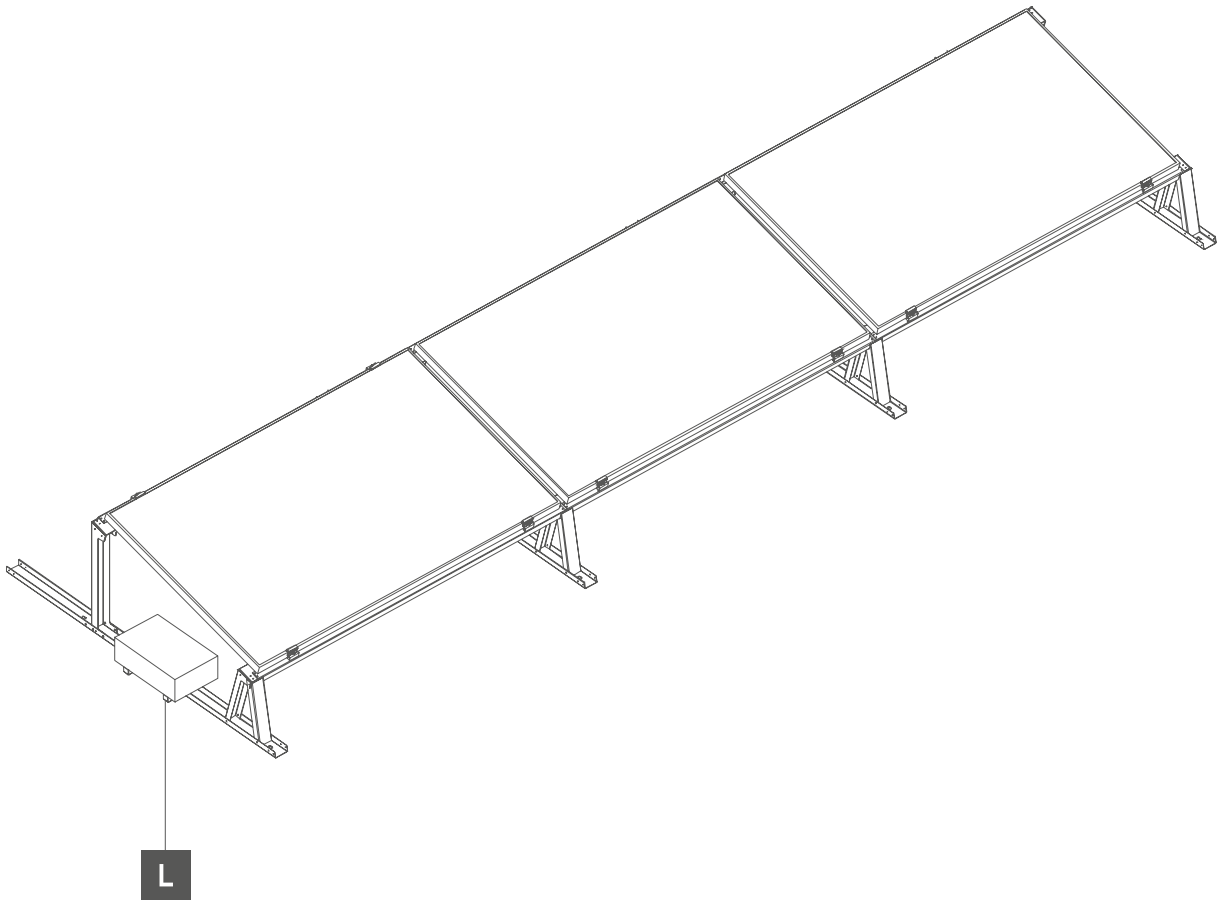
Beispiel für die Anwendung einer Grundlage für einen Betonstein
